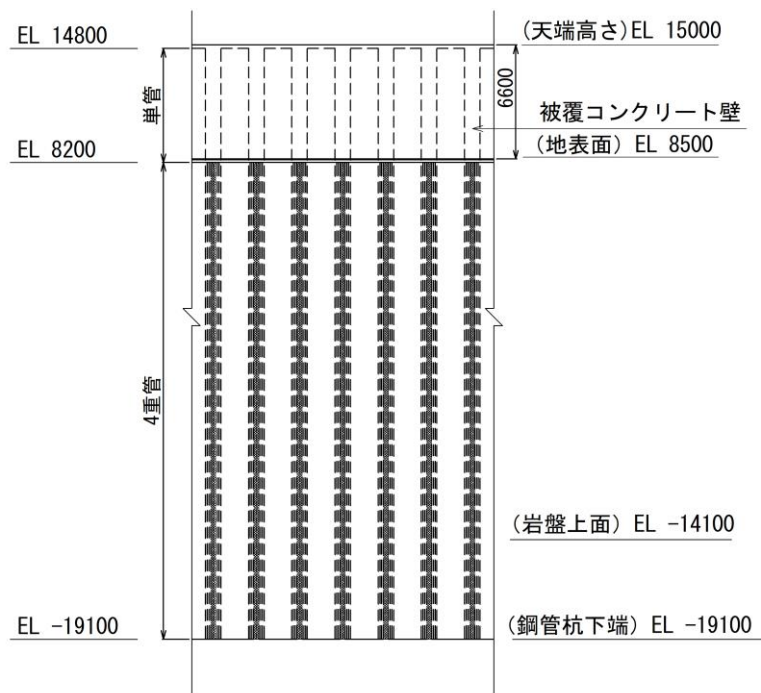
評価対象断面図 (⑥-⑥断面)
